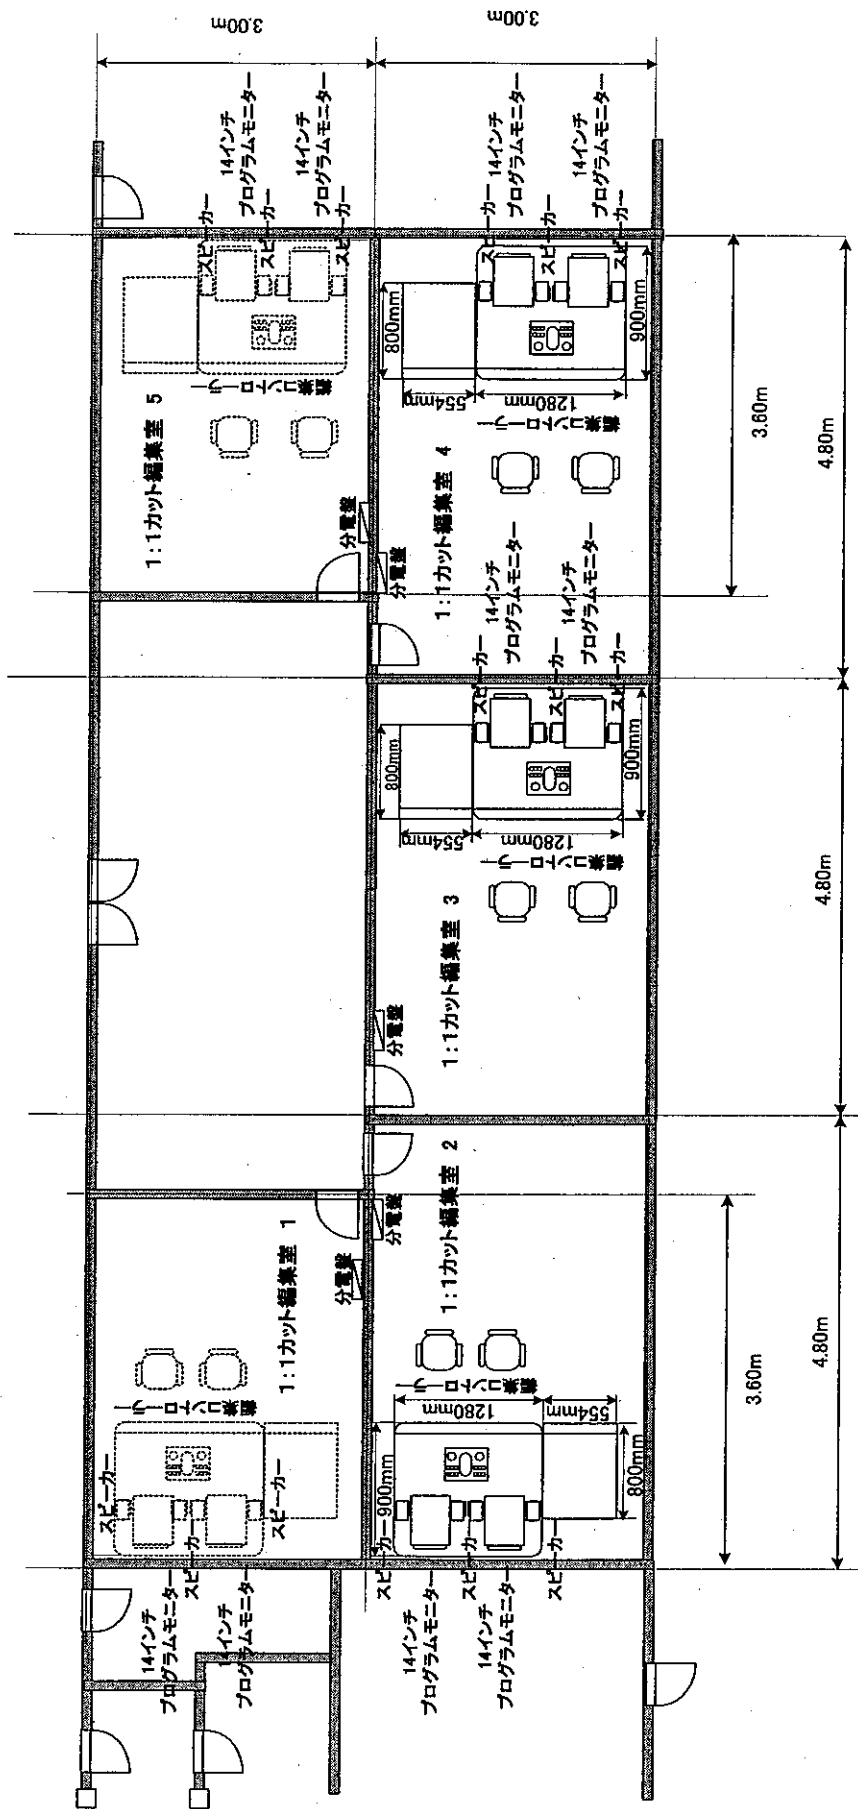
(3/3) 1:1カット編集器 (A方式)、機器配置図
